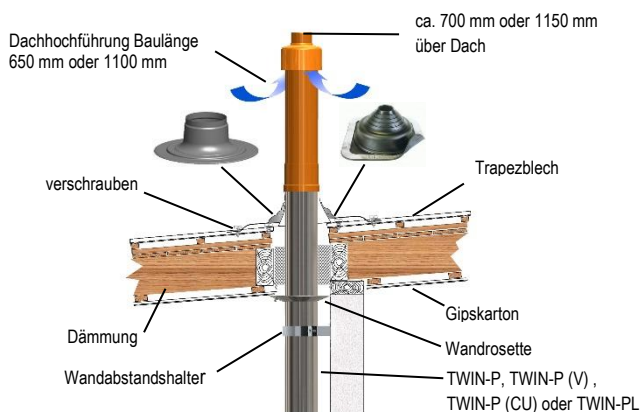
Beispiel Flachdachdurchführung mit Trapezblechdeckung
